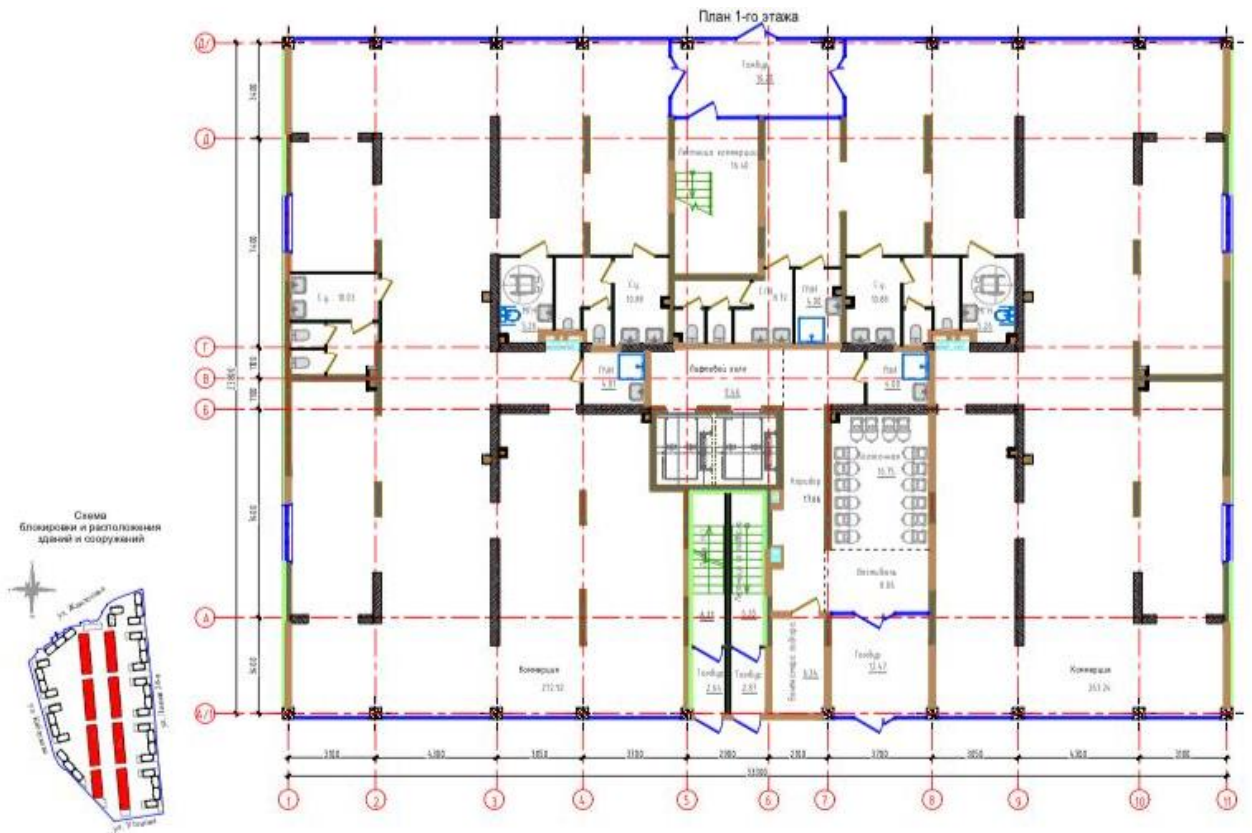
План 1-го этажа «Orda Project» [9]
